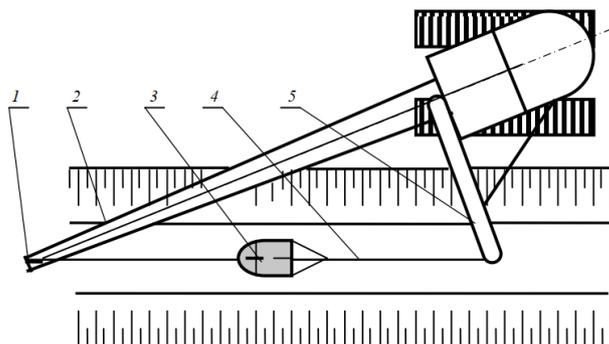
Схема работы бокового драглайна: 1 — поворотный головной блок; 2 — стрела; 3 — ковш; 4 — канаты; 5 — боковая стрела
